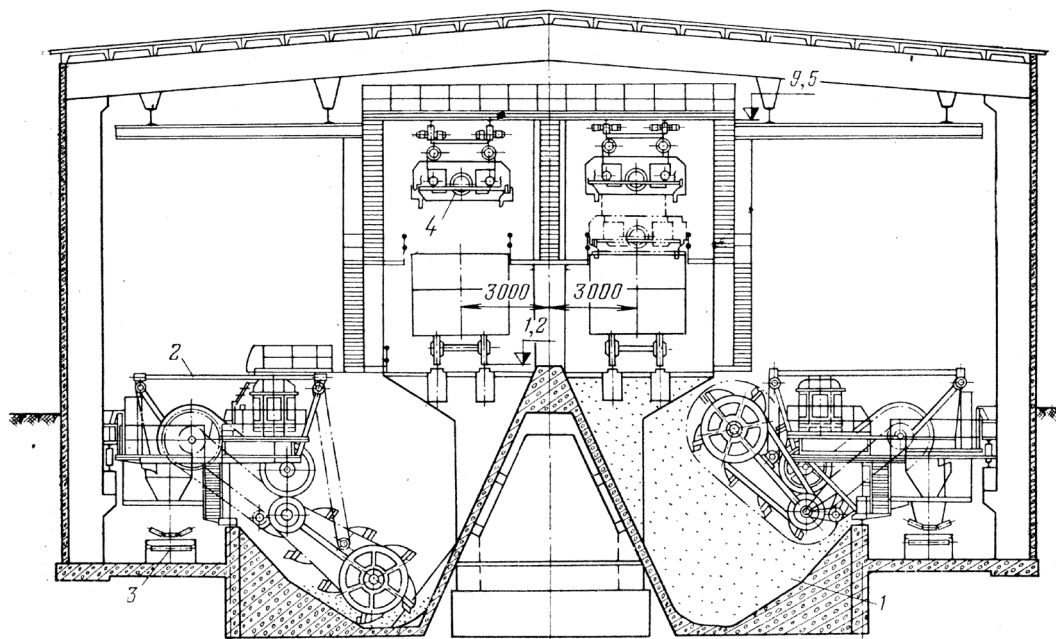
Разгрузочное устройство с багерными перегружателями
